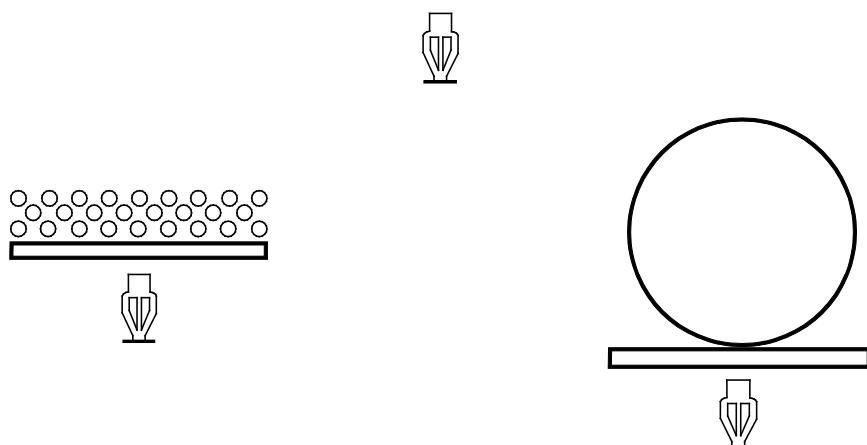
Sprinkleurs supplémentaires installés sous des obstructions pleines, plates et continues d'une largeur comprise entre 1,2 m et 3,0 m.
